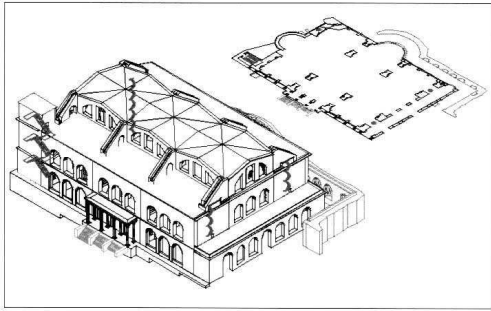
Assonometria ricostruttiva da Sud-Est, e schema planimetrico di riferimento. In verde, in proiezione, le scale che consentivano l'accesso ai piani superiori dell'edificio e la manutenzione delle terrazze e delle finestre. Duplice era invece la funzione delle scale con parapetto, rivestite da uno spesso strato di cocciopesto, ricavate sulla dorsale dei contrafforti. Da un lato, rendevano facilmente raggiungibile la superficie estradossale delle crociere, rivestita di tegole; dall'altro convogliavano l'acqua piovana nelle due terrazze sottostanti, dove veniva probabilmente raccolta da grondaie ricavate sul cornicione perimetrale, e convogliata a terra mediante discendenti esterni, non essendovi alcuna traccia di condotti verticali nelle murature residue. Nello schema di riferimento è indicata in rosso la collocazione della scala a chiocciola, corrispondente a quella effettivamente presente nel lato opposto della Basilica, prevista dal progetto originario ma sostituita in corso d'opera con un nicchione decorato con affaccio sulla via perimetrale Nord.
